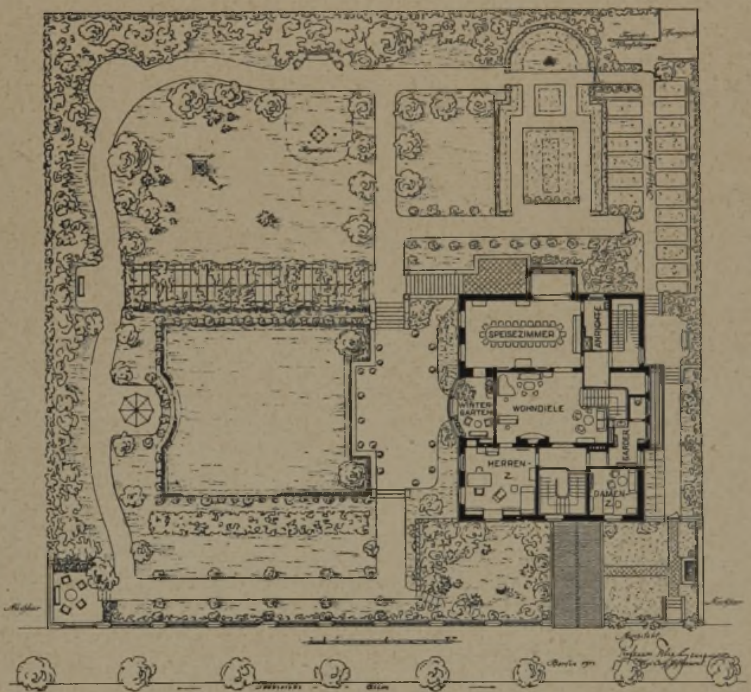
Gartenplan mit Grundriß des Hauptgeschosses. Vom Landhaus Genzmer in Berlin-Dahlem.
